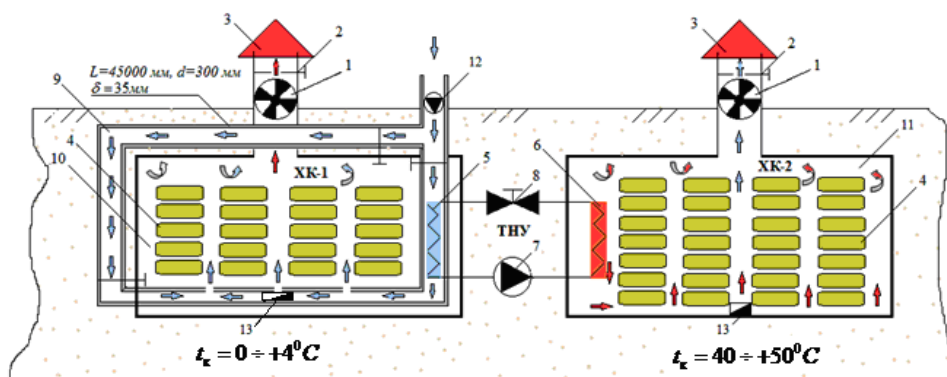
Схема теплохладоснабжения комбинированного подземного плодоовощехранилища с ГАЕХ и ТНУ.
